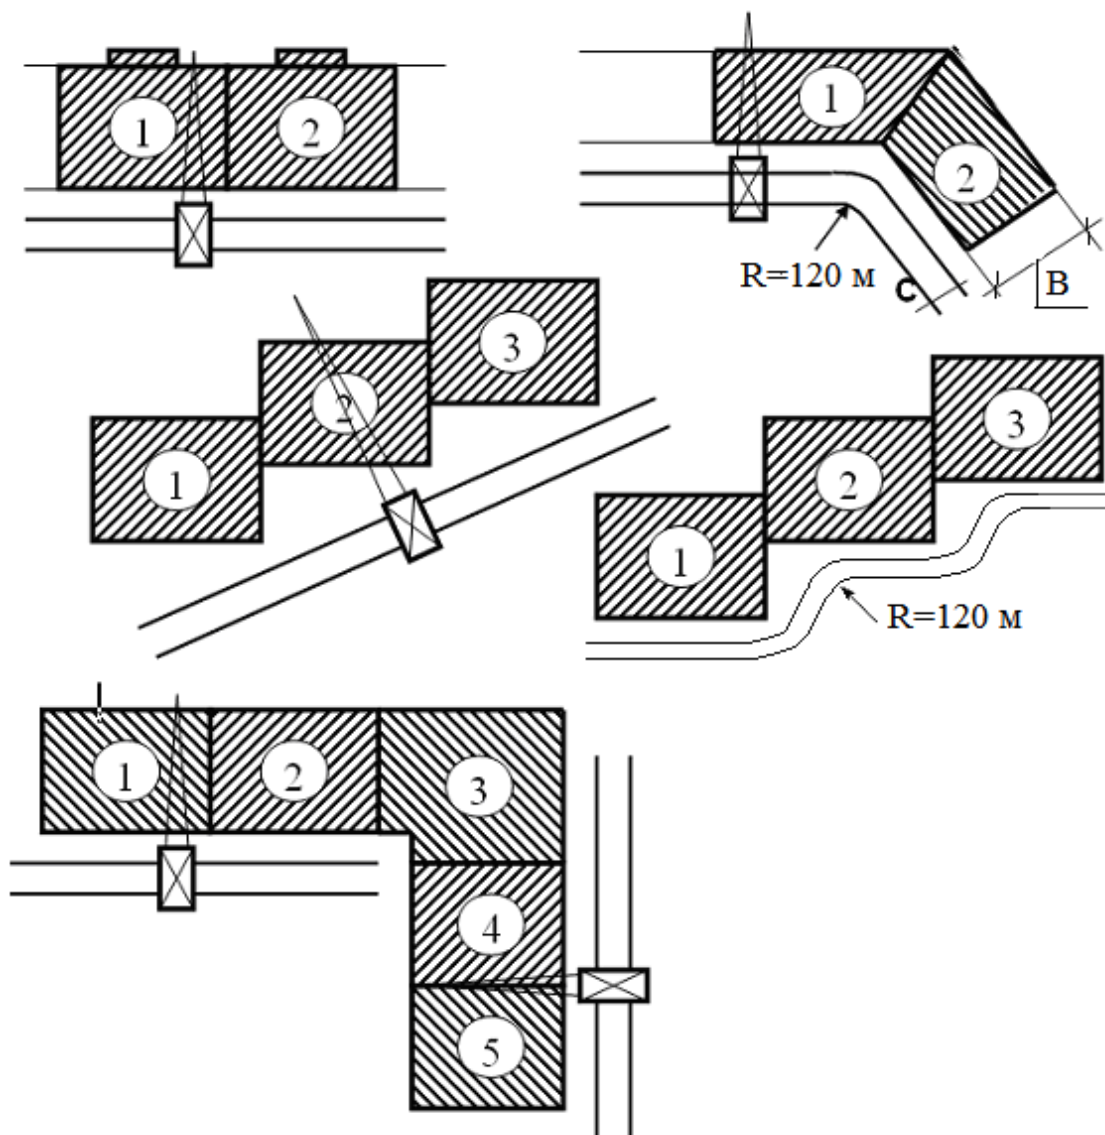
Схемы расстановки кранов при монтаже крупнопанельных зданий
